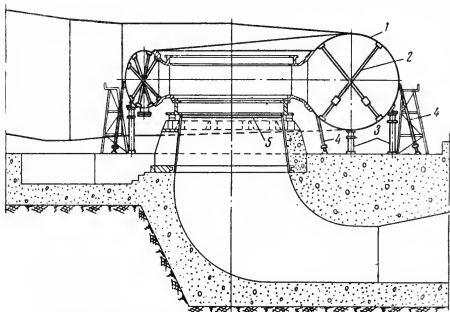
Установочная схема сварной спиральной камеры.
